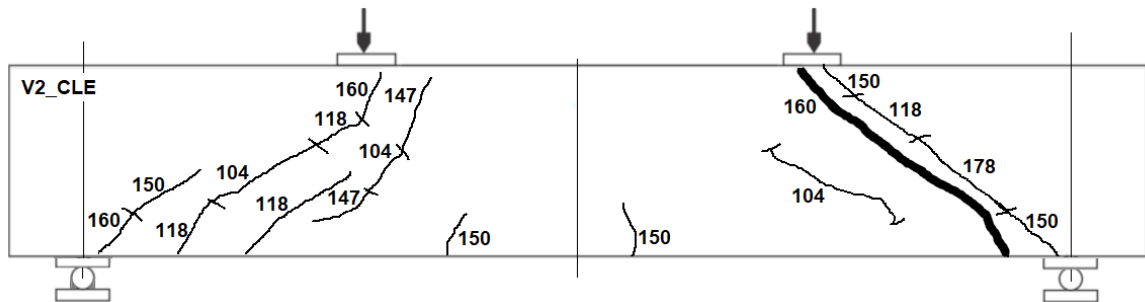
Esquema de fissuração da Viga 2_CLE.
